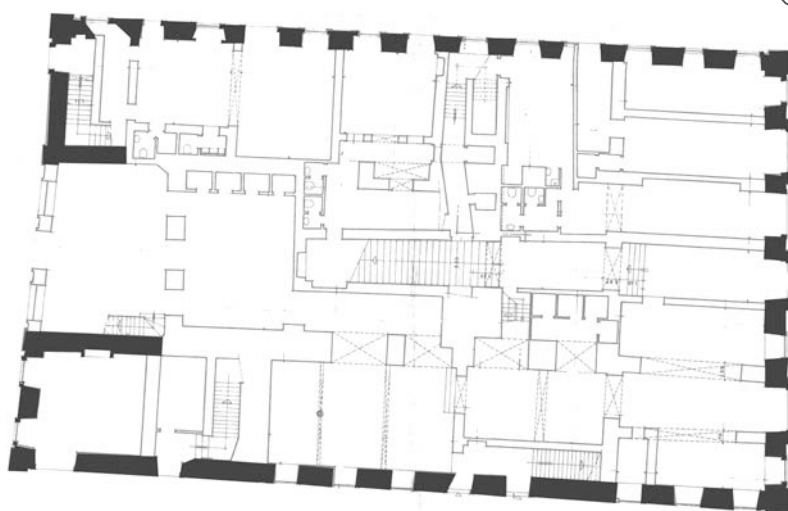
Planta antes das demolições e em corte o que existe hoje (piso 0)
